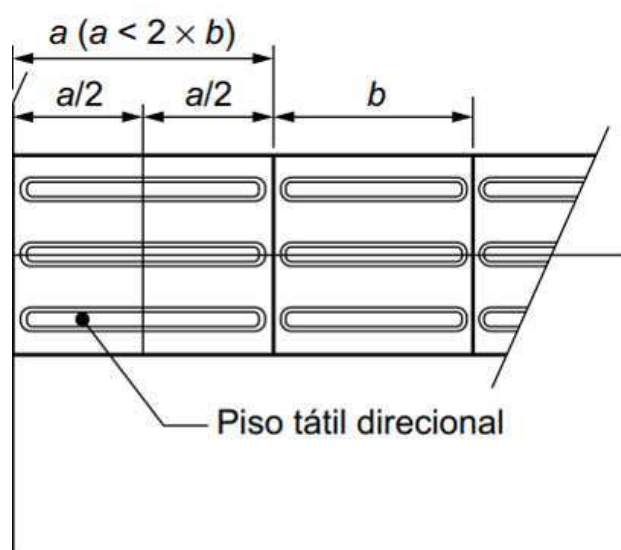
Piso tátil a ser instalado no interior da edificação
